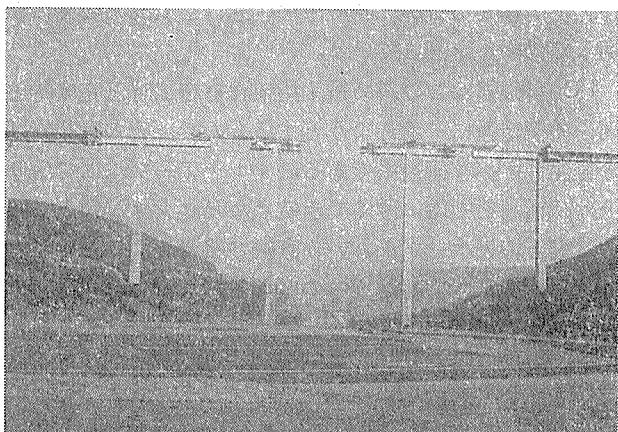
Hilfsträger 工法施工例 (Kochertal Br.)
